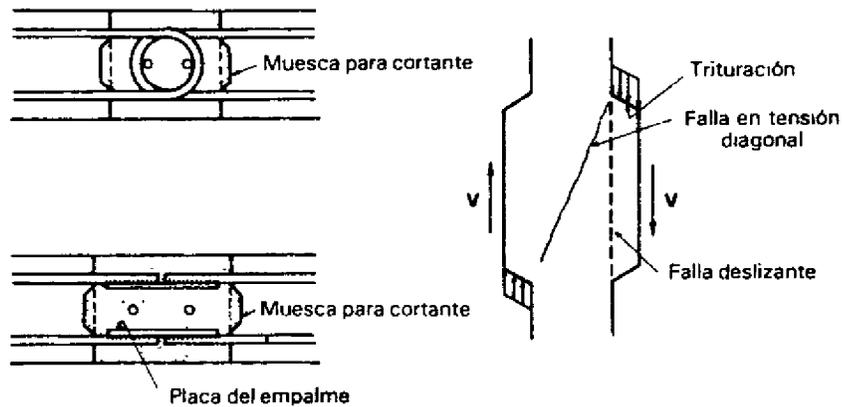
Junta muro-muro (Wakabayashi, 1986).
